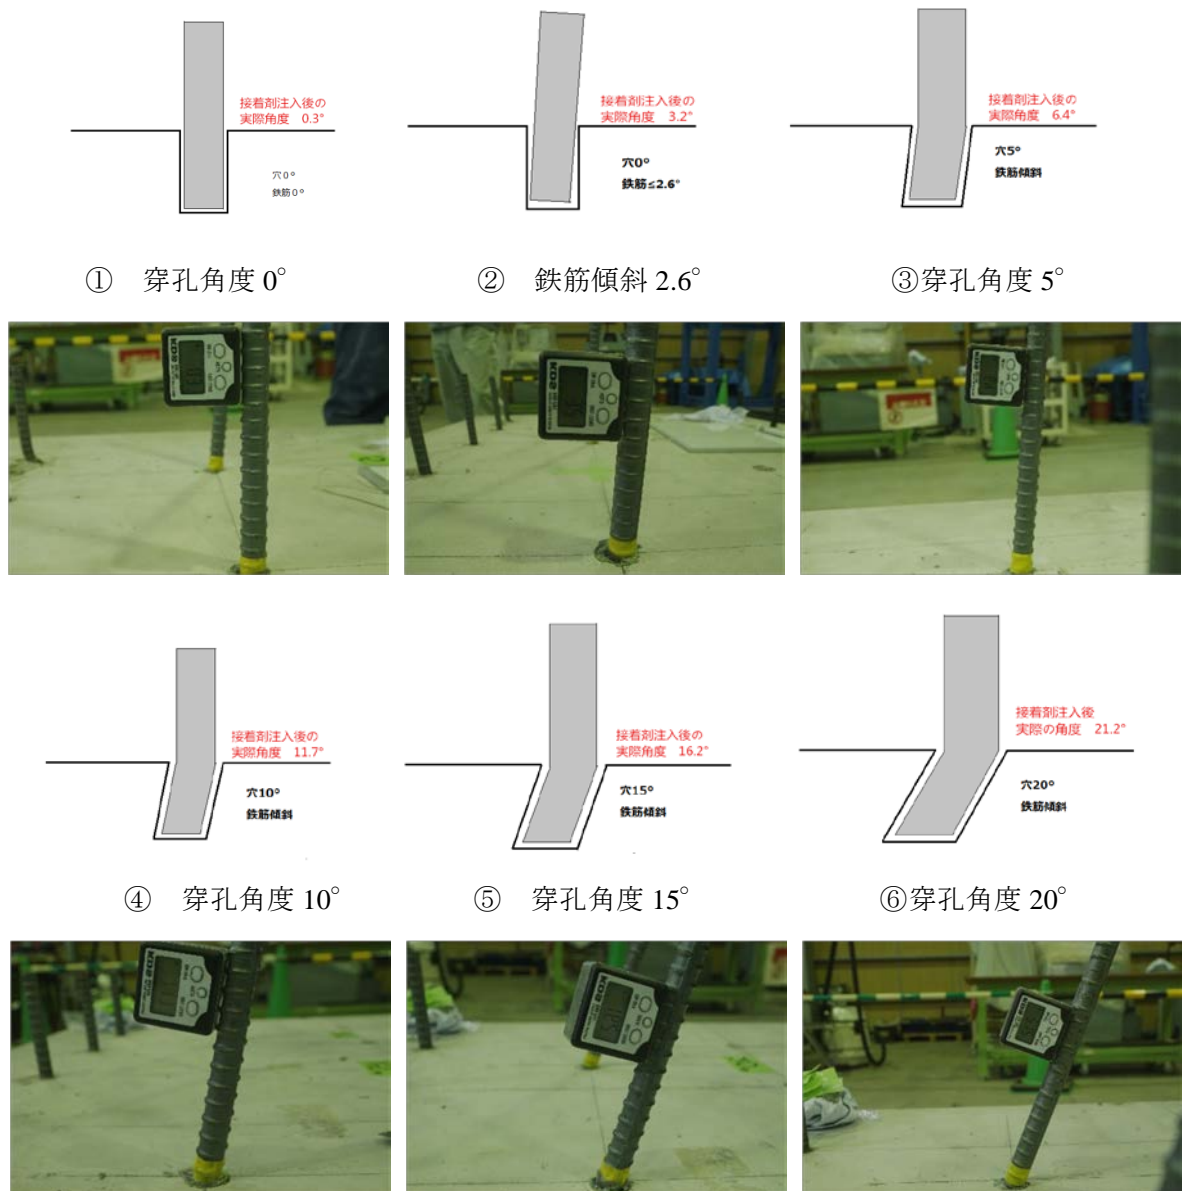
台直し前のアンカー筋施工後の状況
